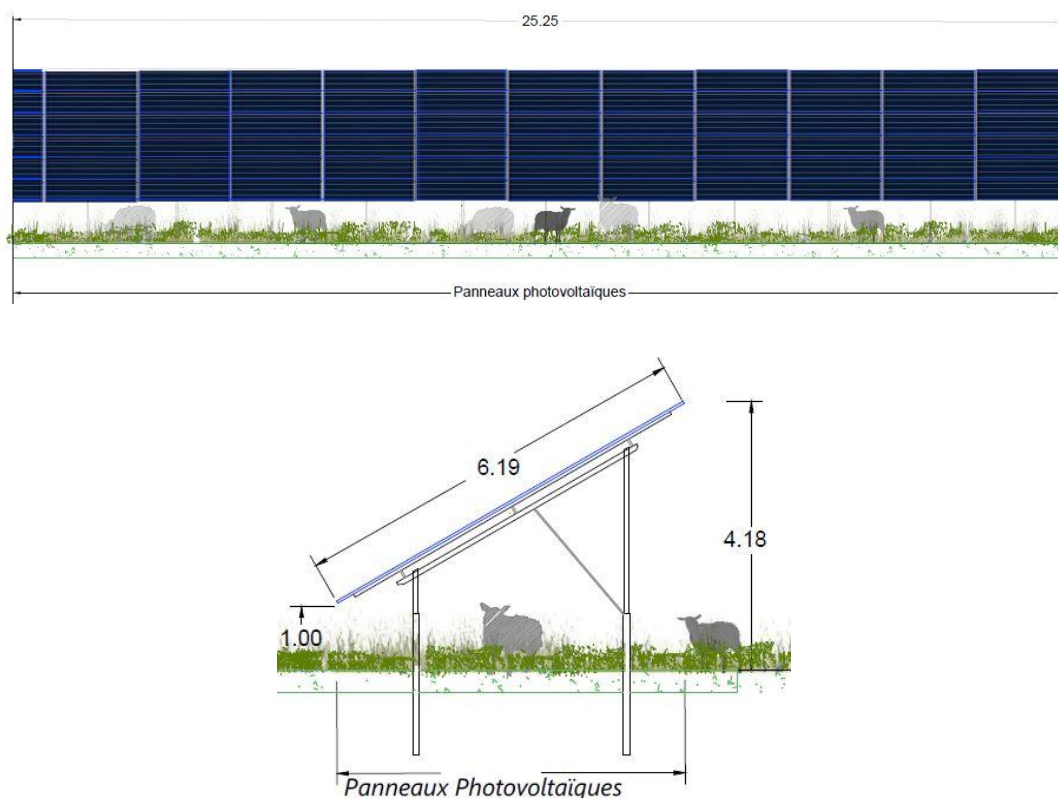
Plans de coupe et façades des tables photovoltaïques
